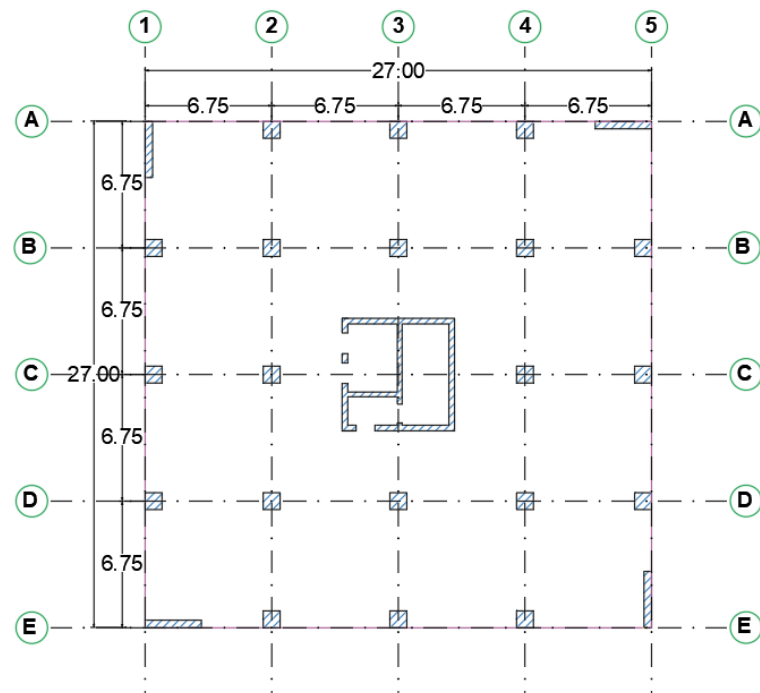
Planta do piso 1 – Variante Estrutural A
